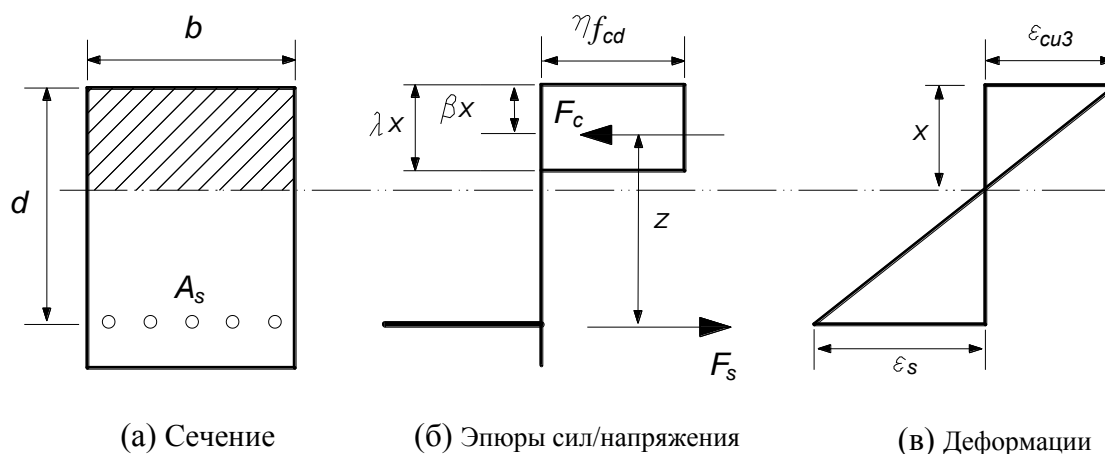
Балка прямоугольного сечения с одиночной арматурой при разрушении (прямоугольная эпюра напряжений в бетоне)
